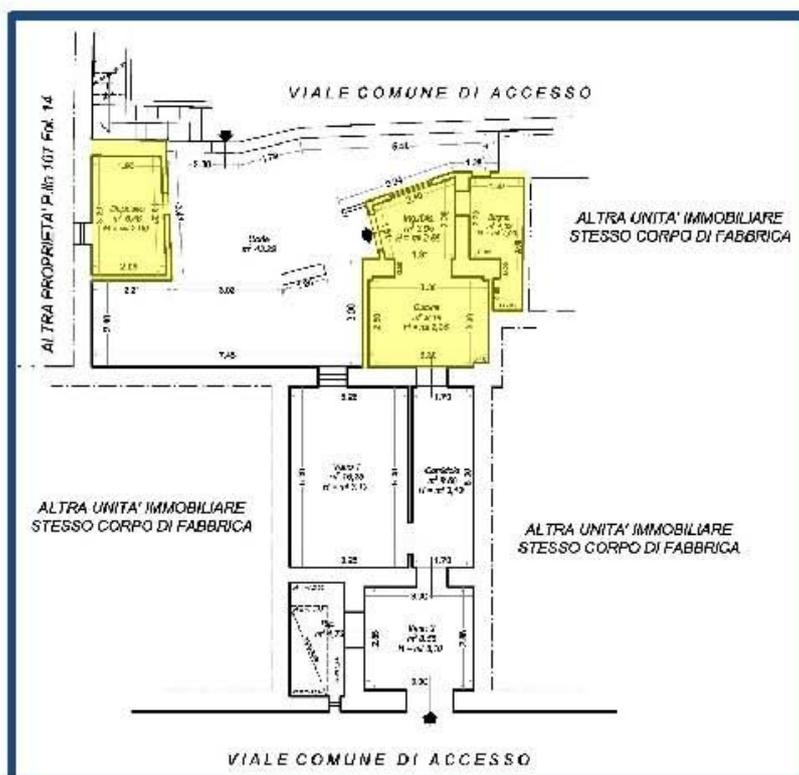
Stralcio Planimetria dell'attuale stato dei luoghi
